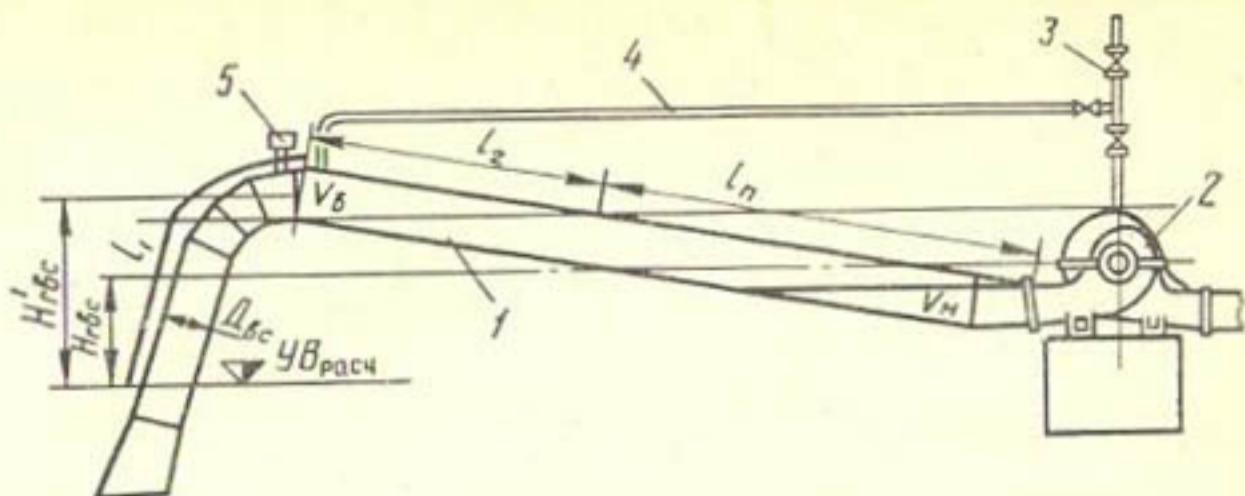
Насосная установка с приподнятой всасывающей трубой:
